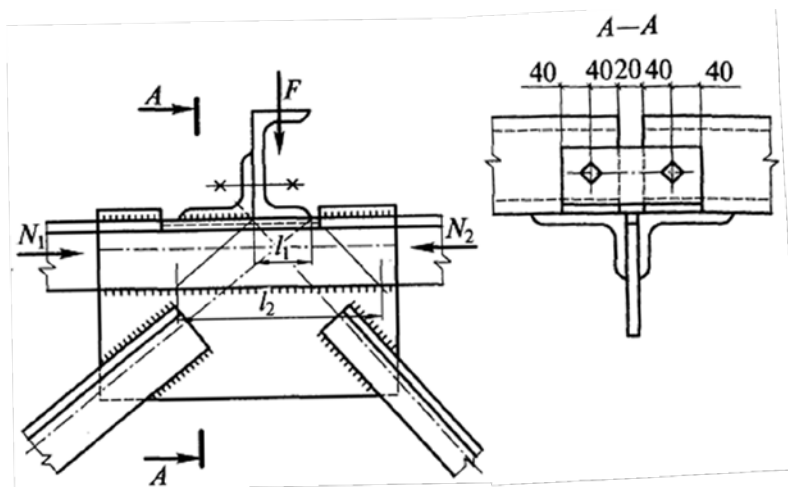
Обпирання прогонів на верхній пояс ферми
